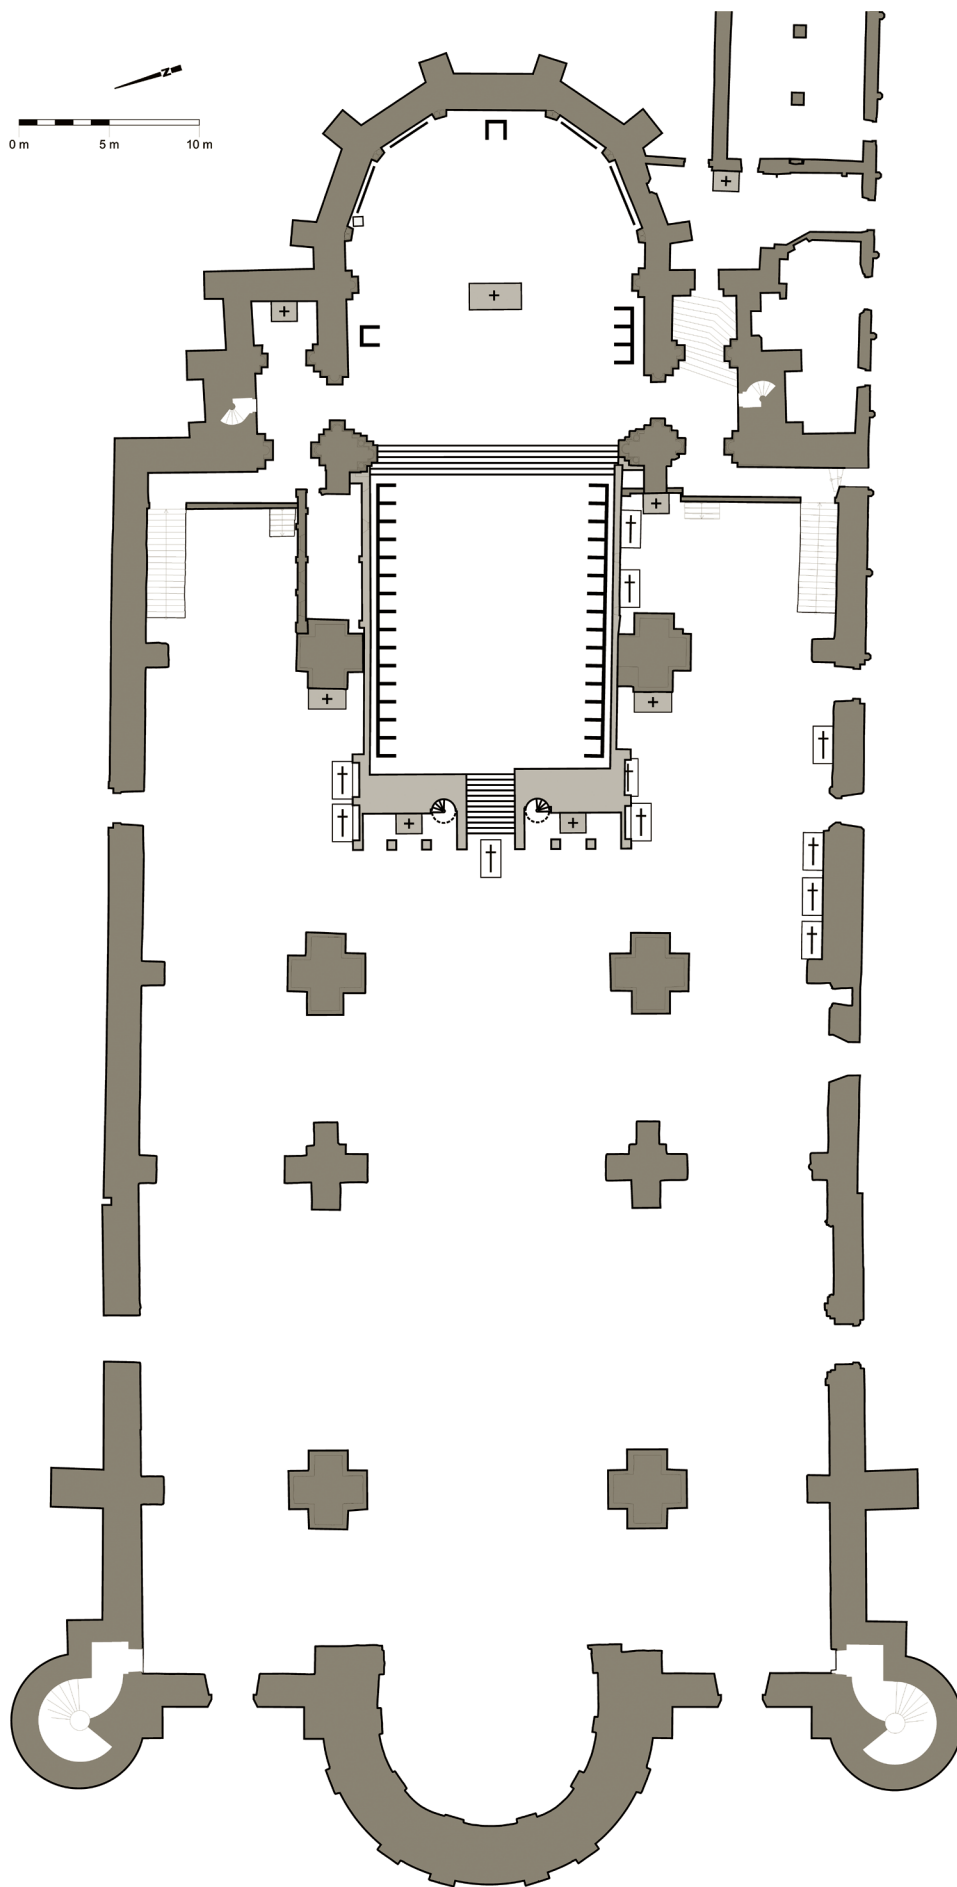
Grundriss des Trierer Domes im 16. Jh. (Rekonstruktion: R. Schneider)
